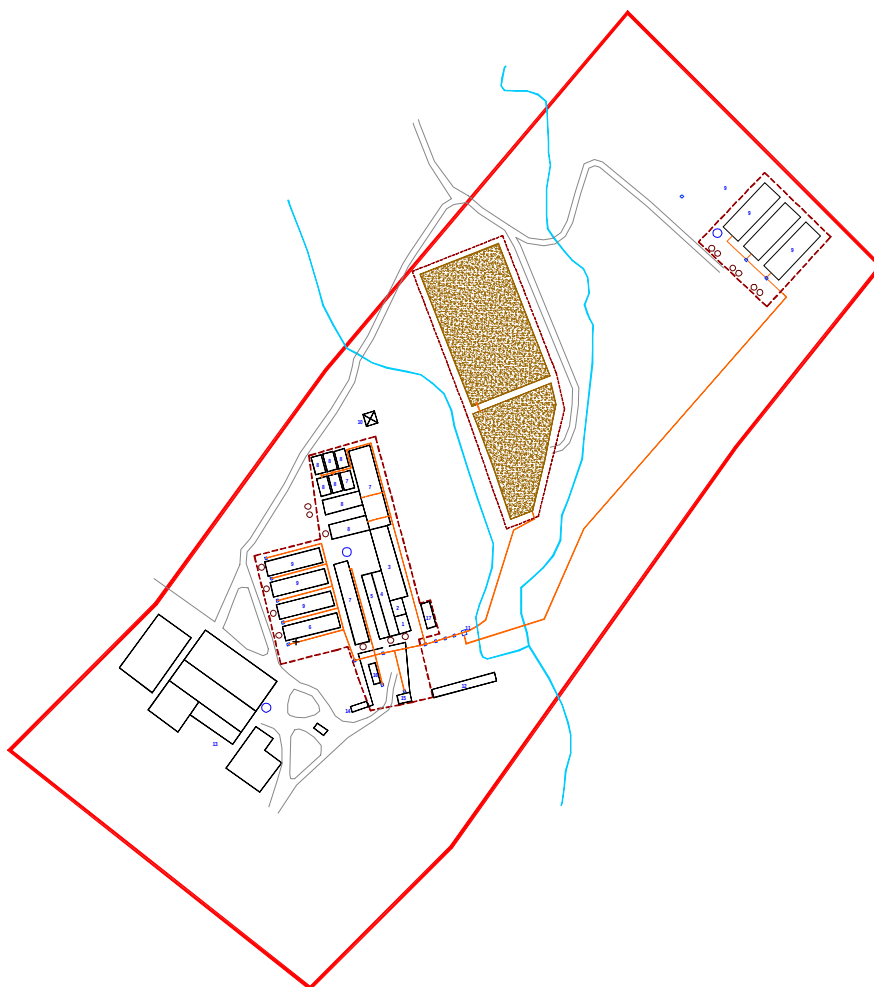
Planta de localização do sistema de retenção de águas residuais.
